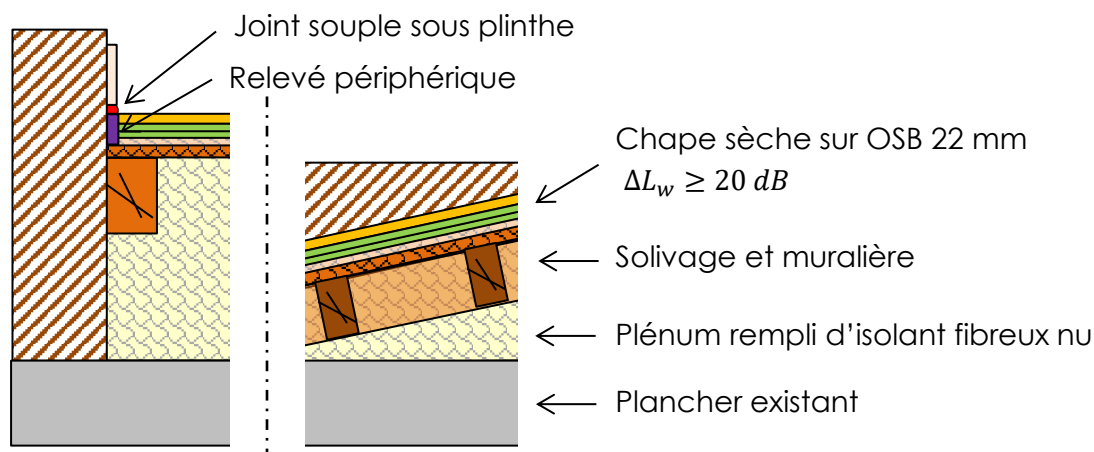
Schéma de principe en coupe – Rampe d'accès PMR
